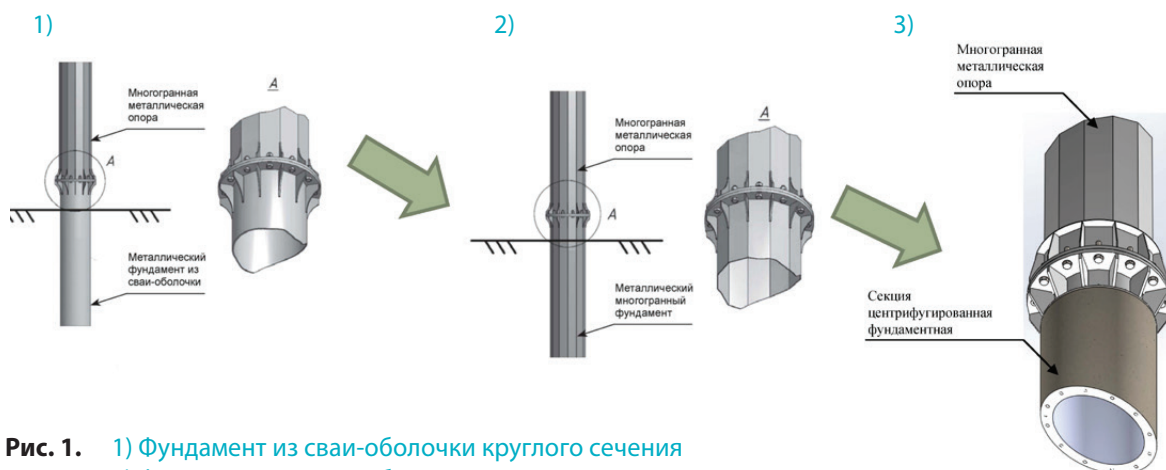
1) Фундамент из сваи-оболочки круглого сечения
